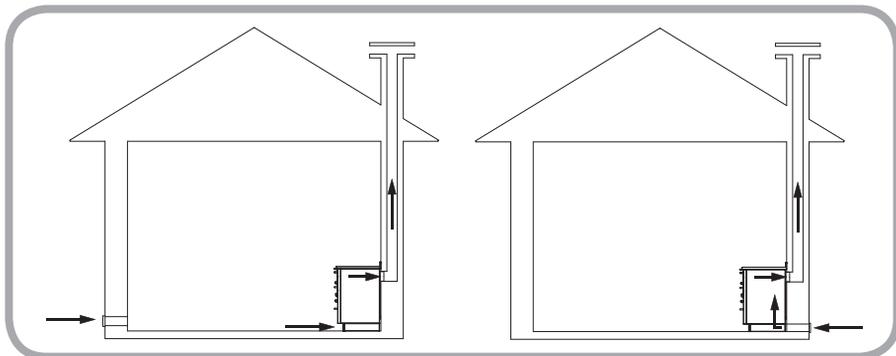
Installazione mediante presa d'aria nel locale e installazione con presa d'aria esterna collegata direttamente alla cucina a legna.
